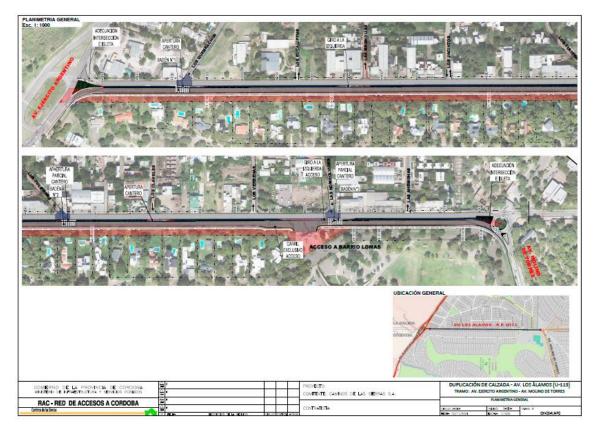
Plano de proyecto vial. En Anexo en escala de detalle
